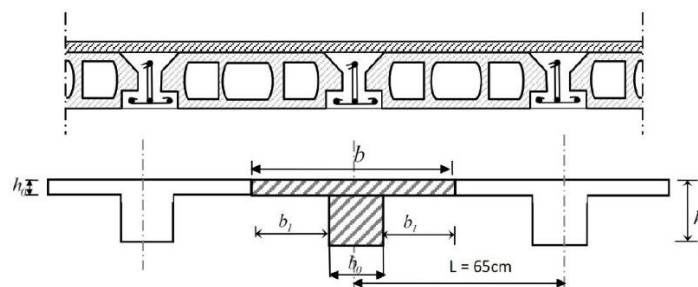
Coupe d'un plancher à corps creux et schéma explicatif de la poutrelle.
